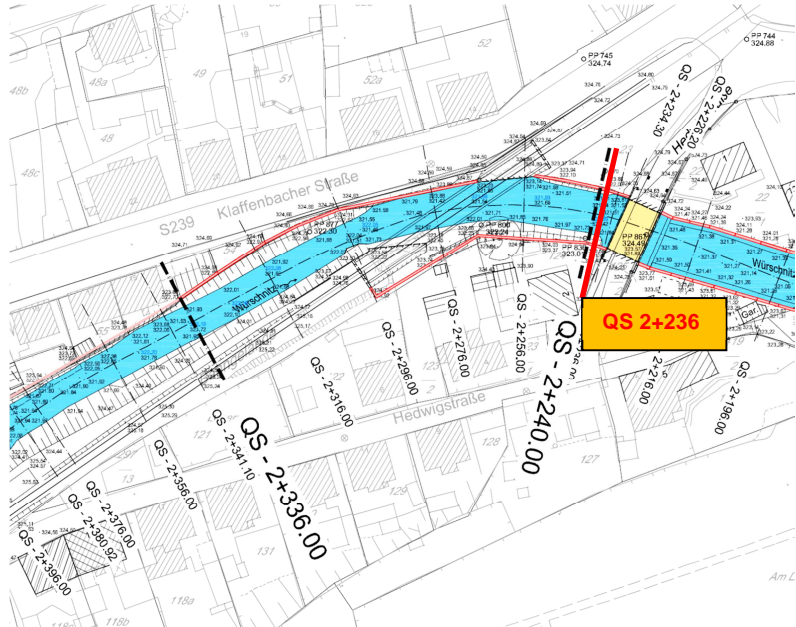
4.5.3.: Lageplanausschnitt mit Schnittpuren 2+240 und 2+336
